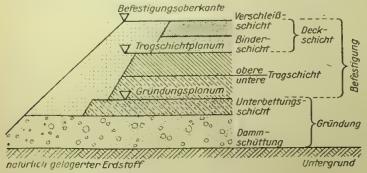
Konstruktionsschichten im Straßenbau
